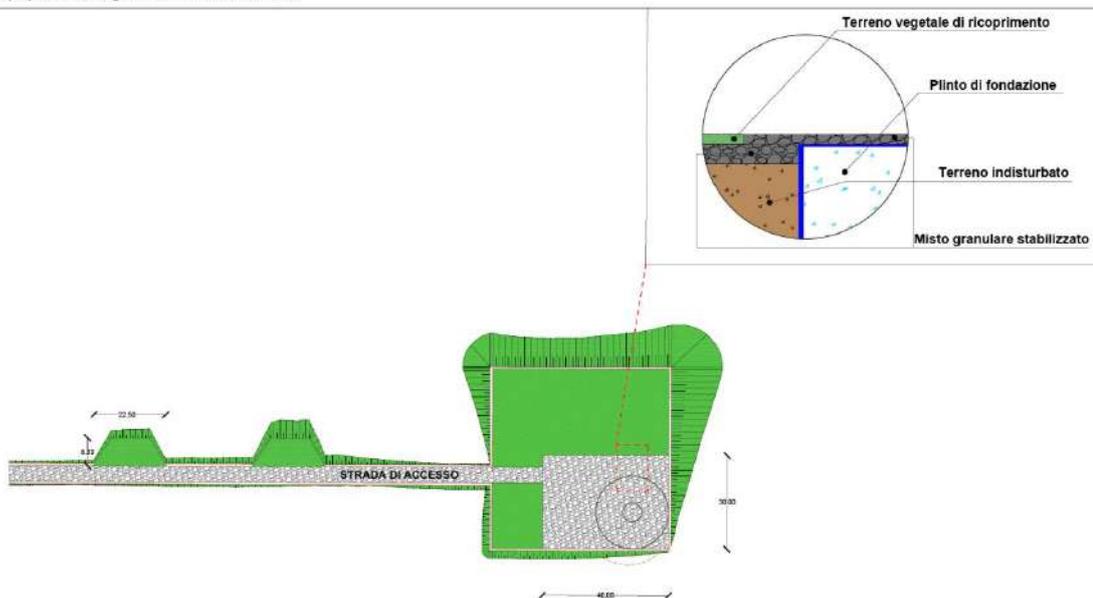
Planimetria piazzola tipo in fase di esercizio
